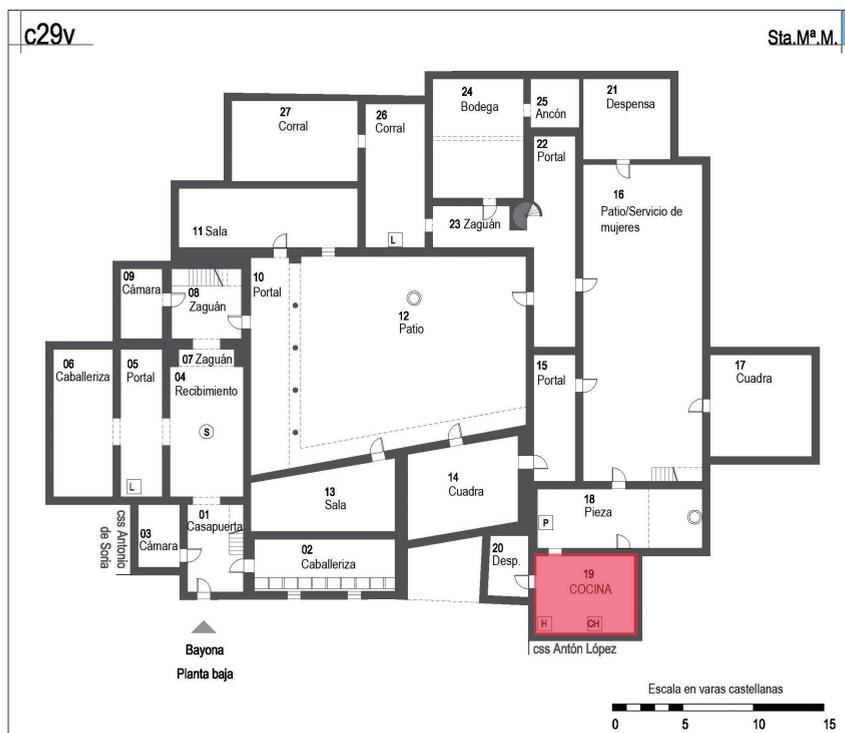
Dibujo de la planta baja de una casa en la c. Bayona (c29v),
